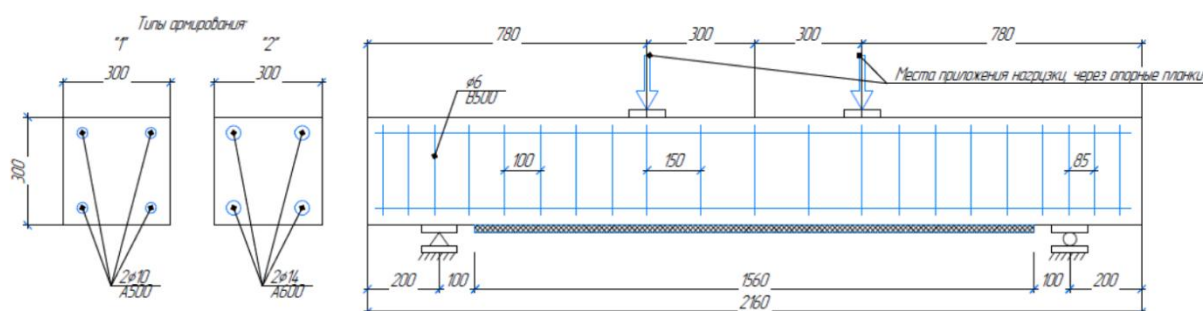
Схема армирования и приложения нагрузки экспериментальных балок
